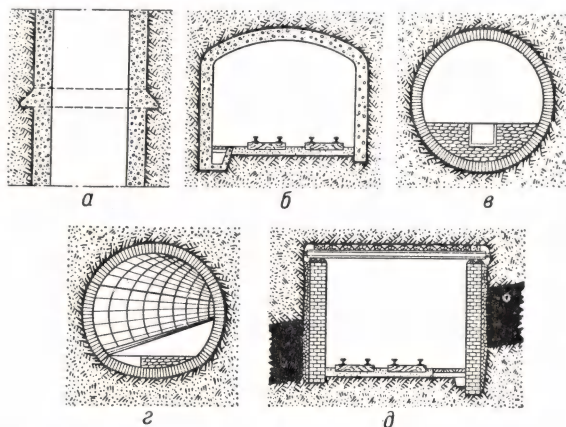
Крепь капитальных горных выработок: а — бетонная крепь вертикального ствола (продольный разрез); б — сводчатая бетонная крепь; в — крепь круглого сечения из бетонных камней; г — крепь овальной формы из бетонных камней; д — крепь с прямыми кирпичными стенами и плоским перекрытием из металлич. балок.
